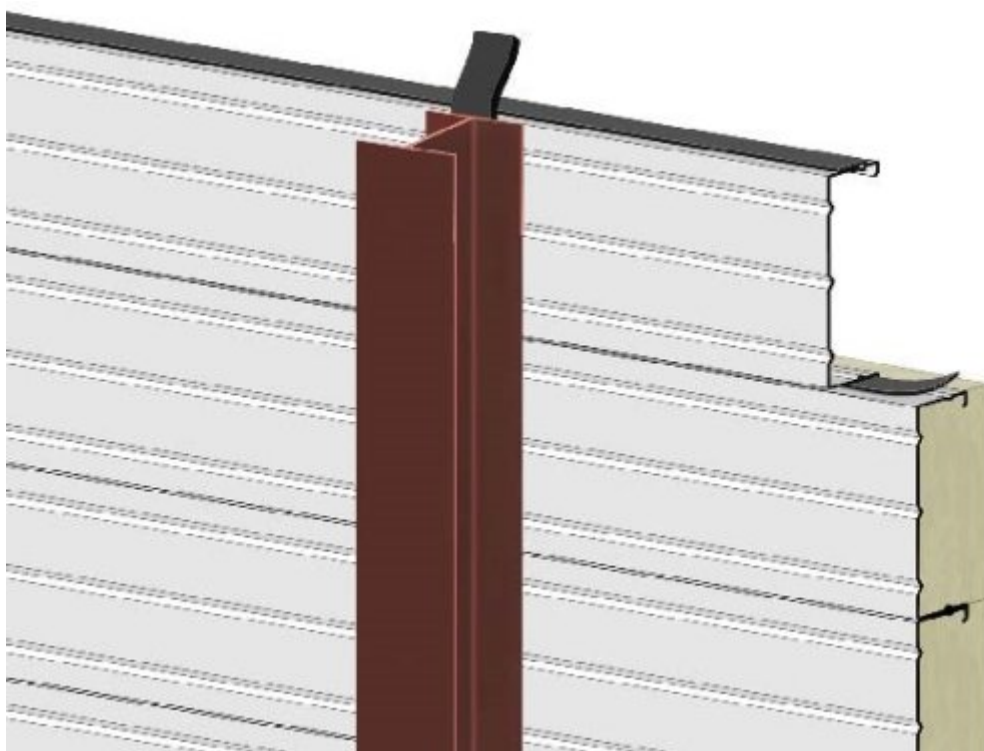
bis – Mise en place du joint d'étanchéité SUPER ETANCOPAST sur plateaux métalliques pleins
